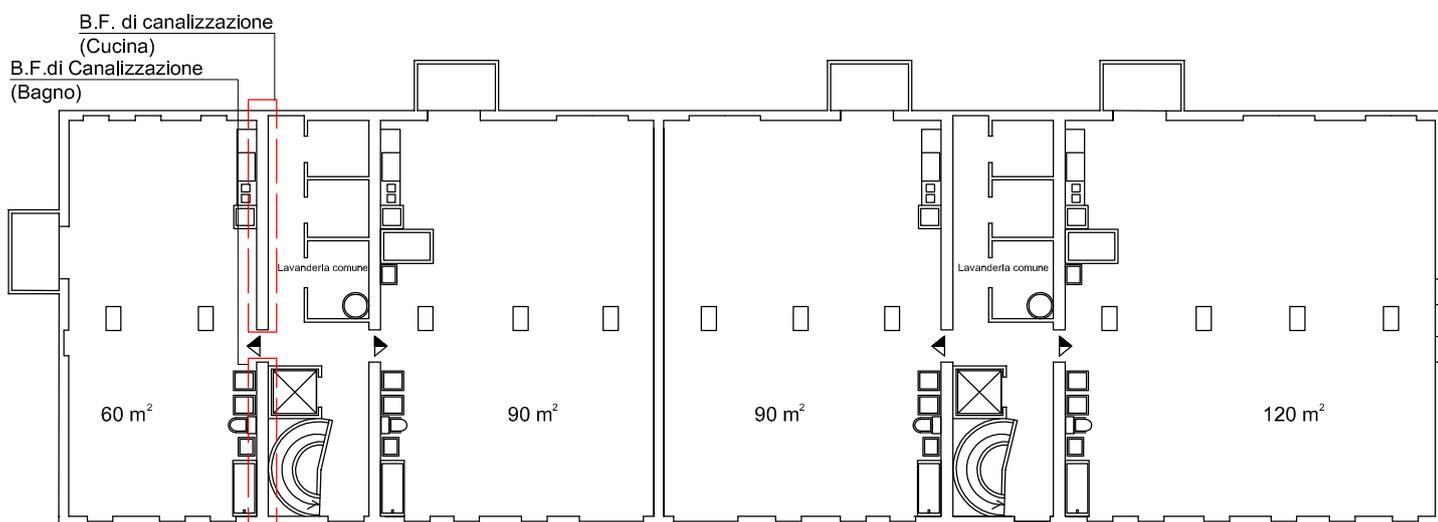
Pianta interna appartamenti da 60 e 90 e 120mq.
